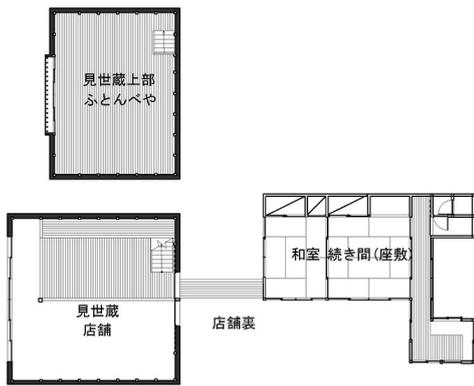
栃木時代の家 推定復元平面図 (作成者: 友田博通氏)
